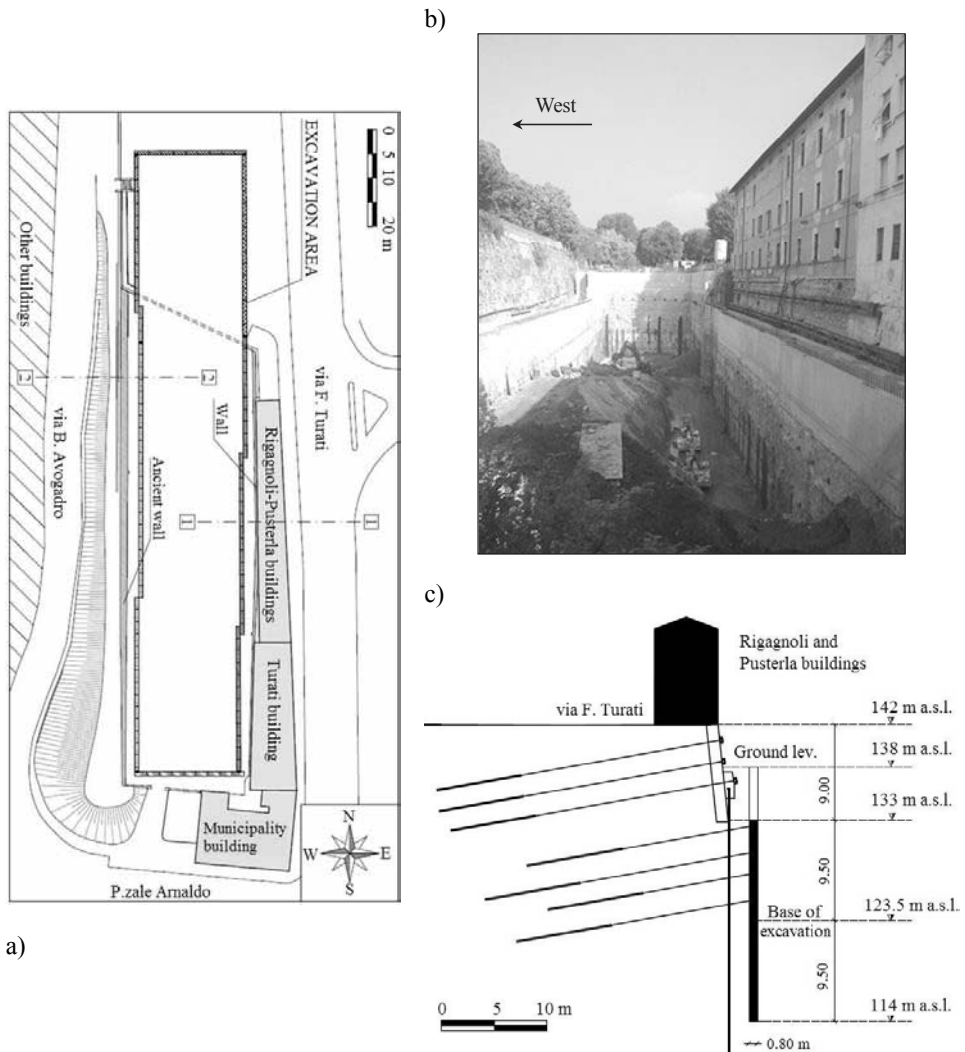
a) Planimetria; b) immagine fotografica cantiere; c) schema costruttivo del parcheggio interrato di Piazzale Arnaldo a Brescia
